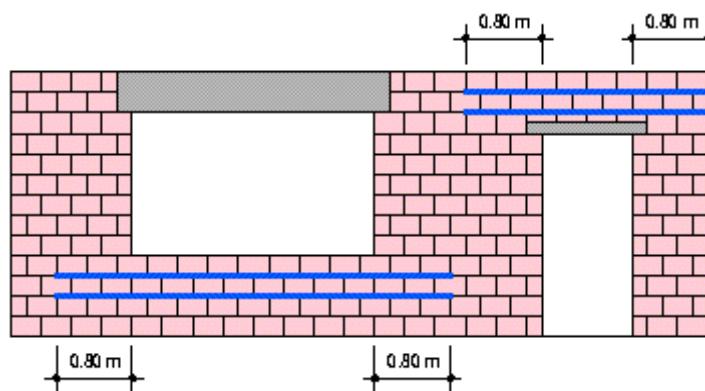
Горизонтальное армирование стен в зоне оконных и дверных проемов
